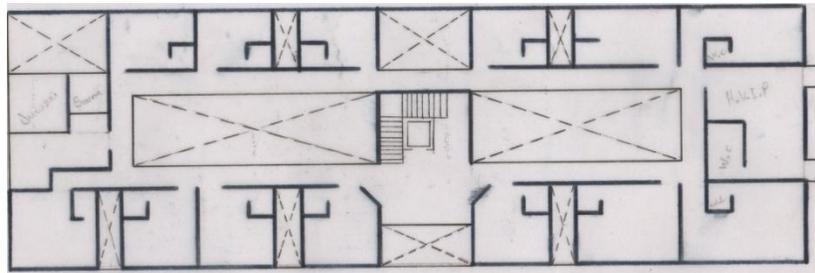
Dibujo planta Distribución arquitectónica/ Sebastián. M
